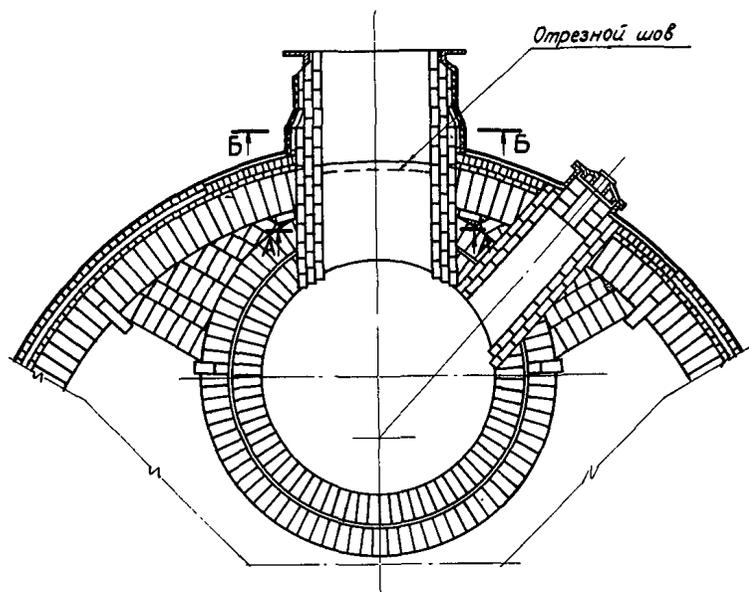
Кладка штуцера газовой горелки и лаза с луком для зажигания :
